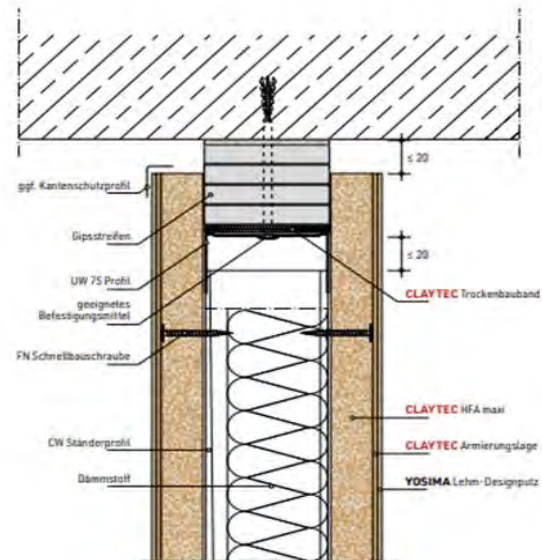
Anschluss an Massivdecke gleitend, für Brandschutzanforderungen geeignet. Gipsblock an Betondecke befestigt, Ständerprofile gekürzt und nicht mit Anschlussprofil und Gipsblock verbunden
